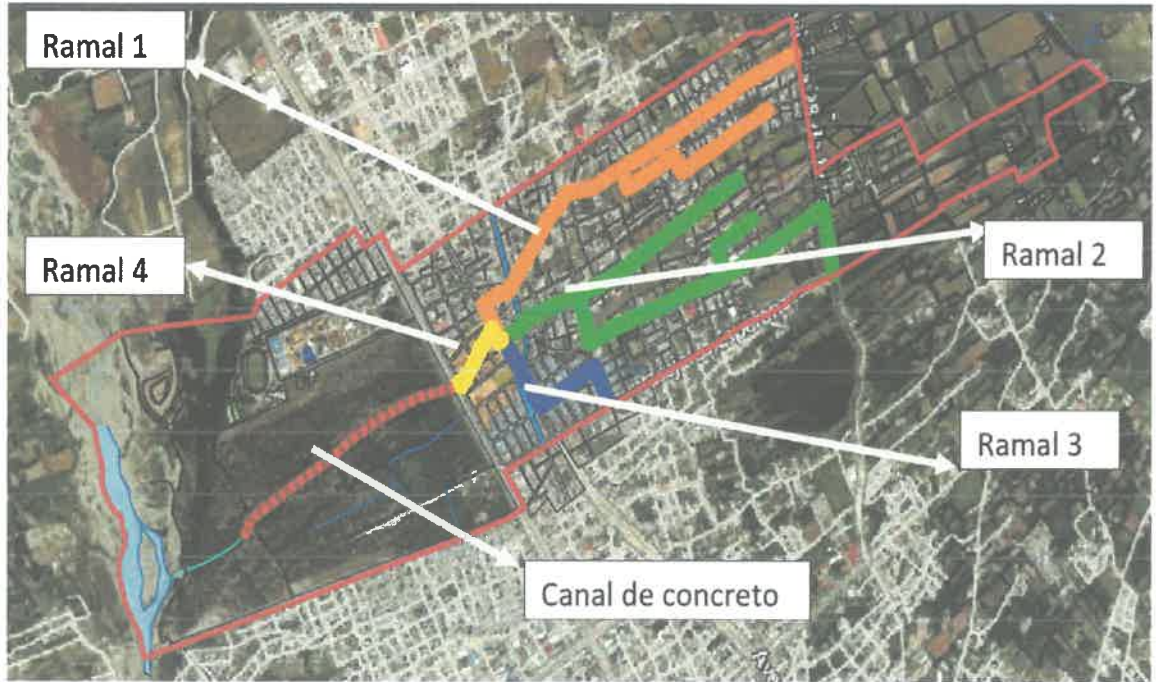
Planteamiento general del sistema de drenaje pluvial del sector NG 16
